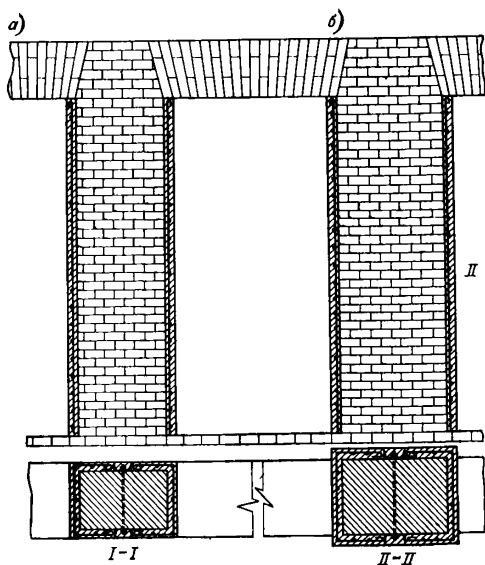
Усиление кирпичного простенка железобетонной обоймой
